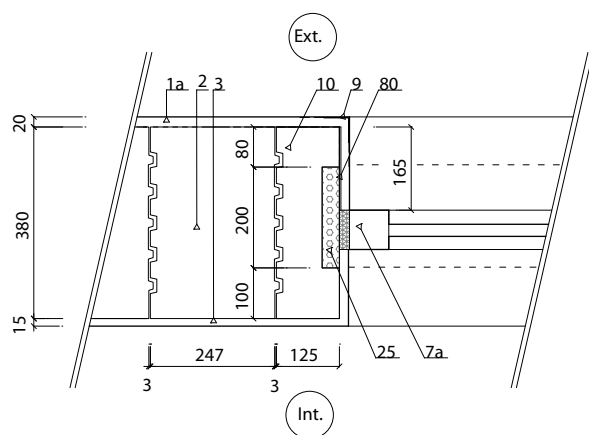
Půdorys – okenní ostění – s omítkou
